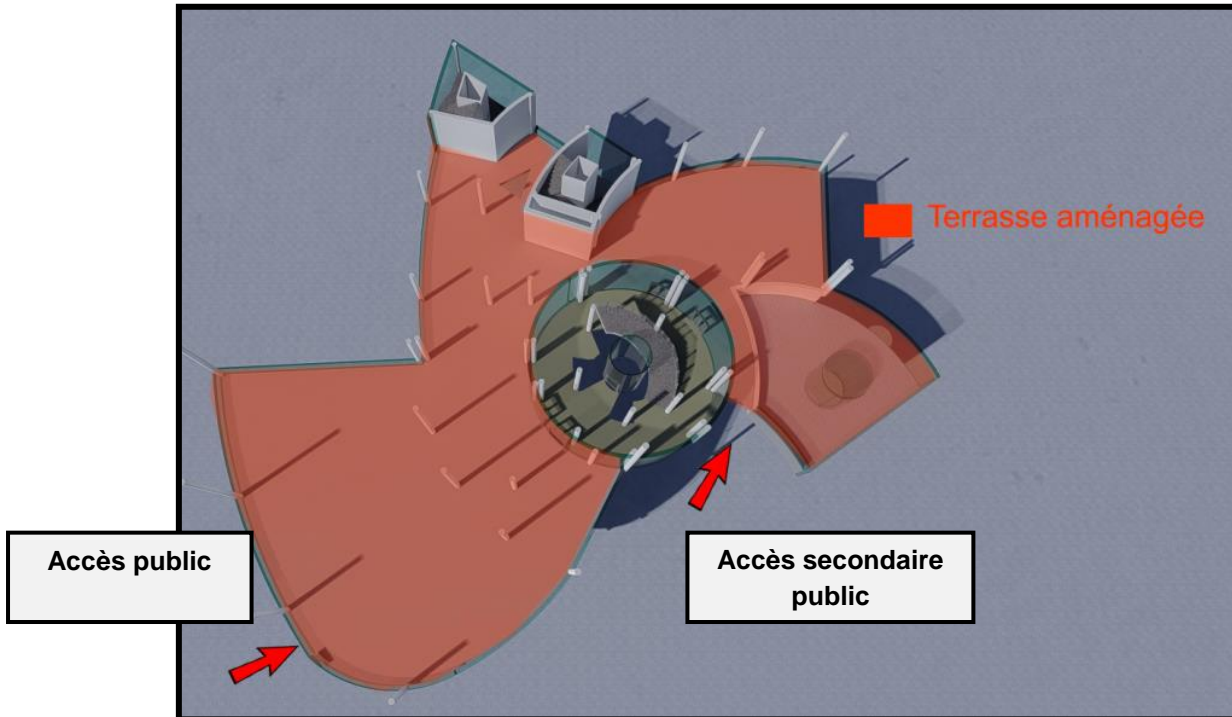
vus 3d de plan de 2^{eme} étage (auteur)
